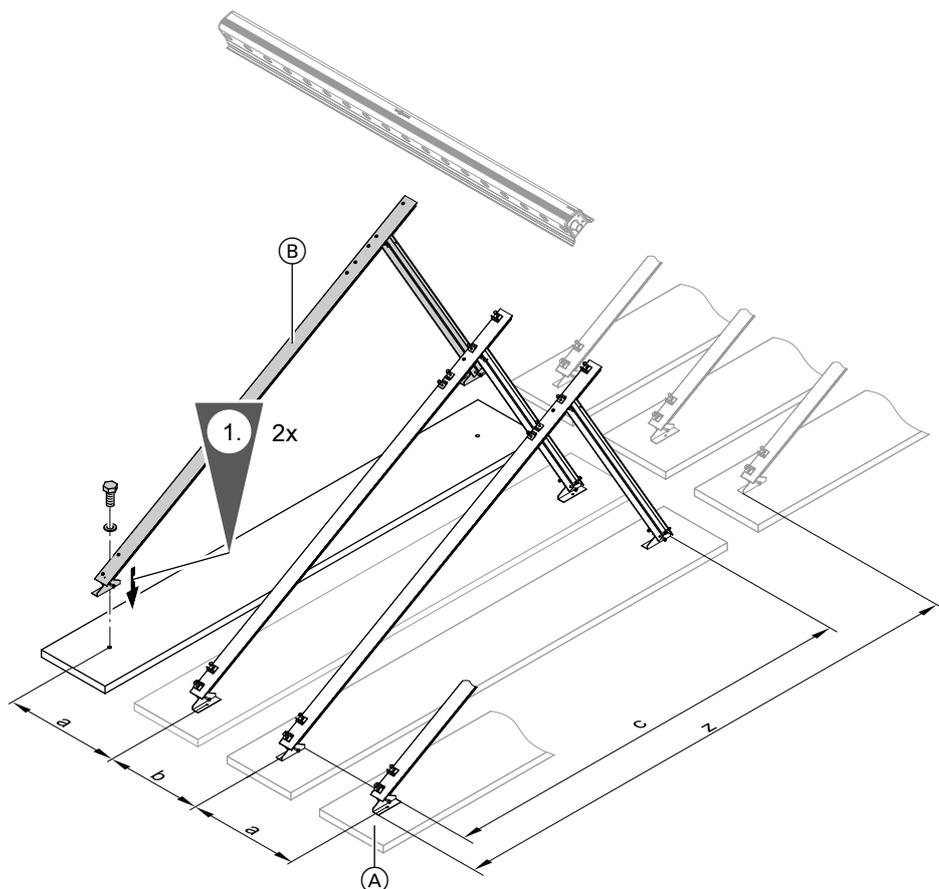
BefestigungsfüÙe als Bohrschablone benutzen.
